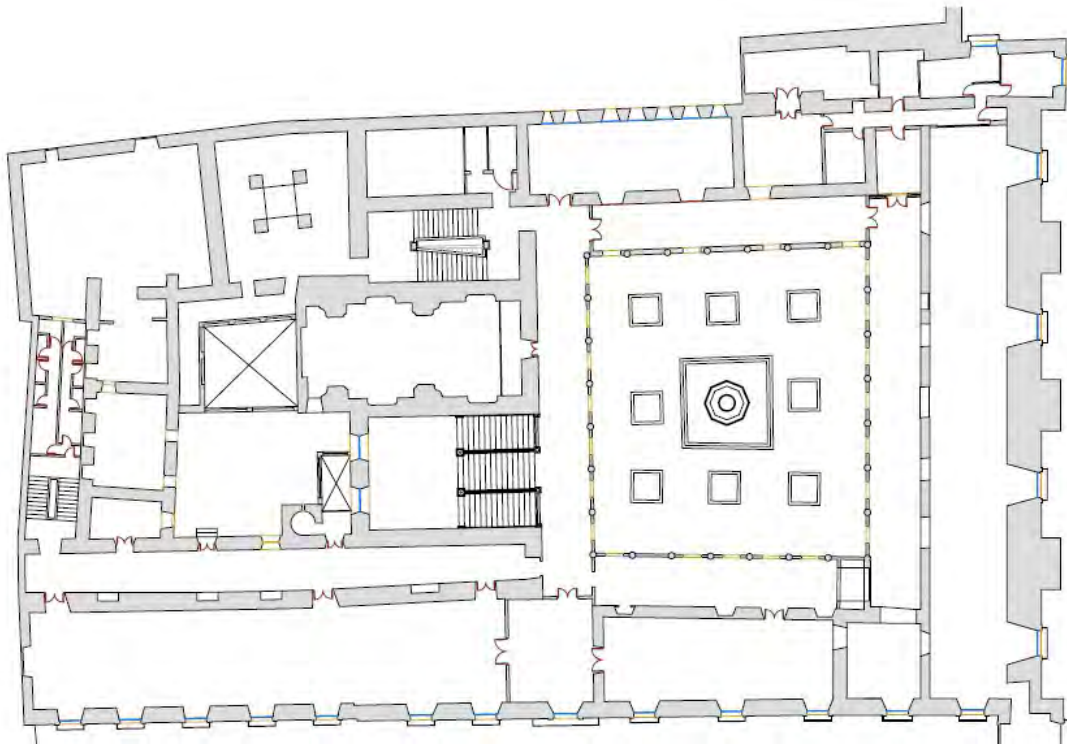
Estado previo. Planta primera (OAFJ, fragmento del plano A02).
